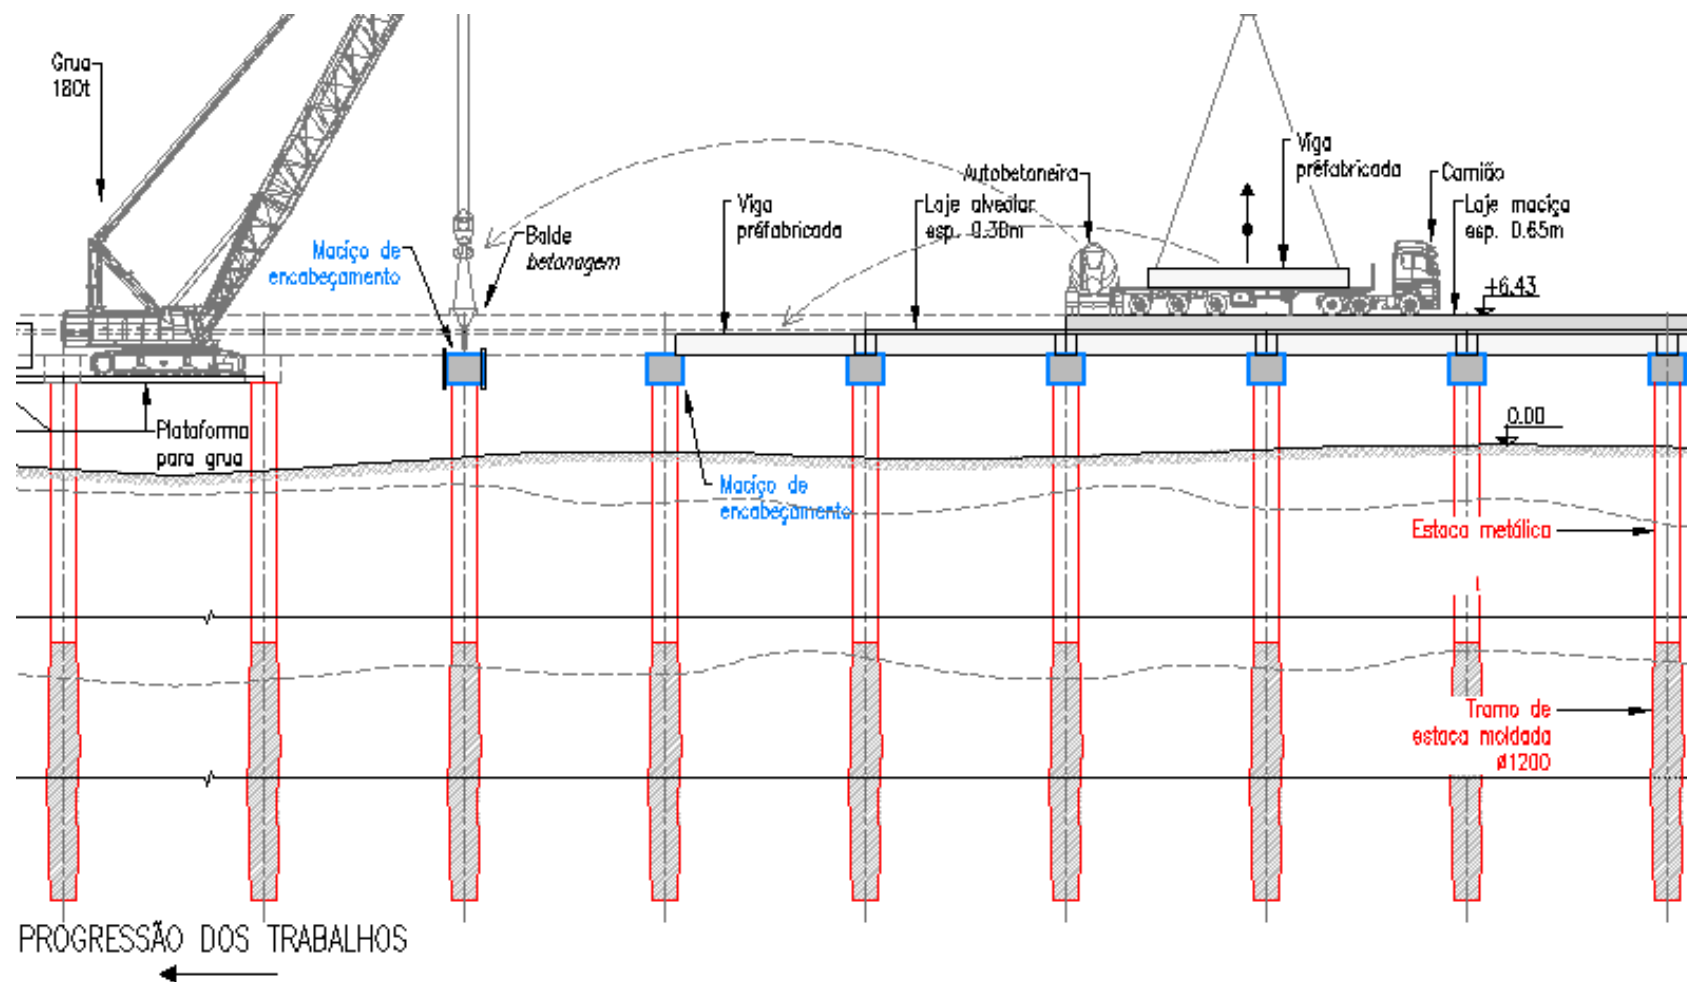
Fase 4 – Execução faseada da superestrutura
